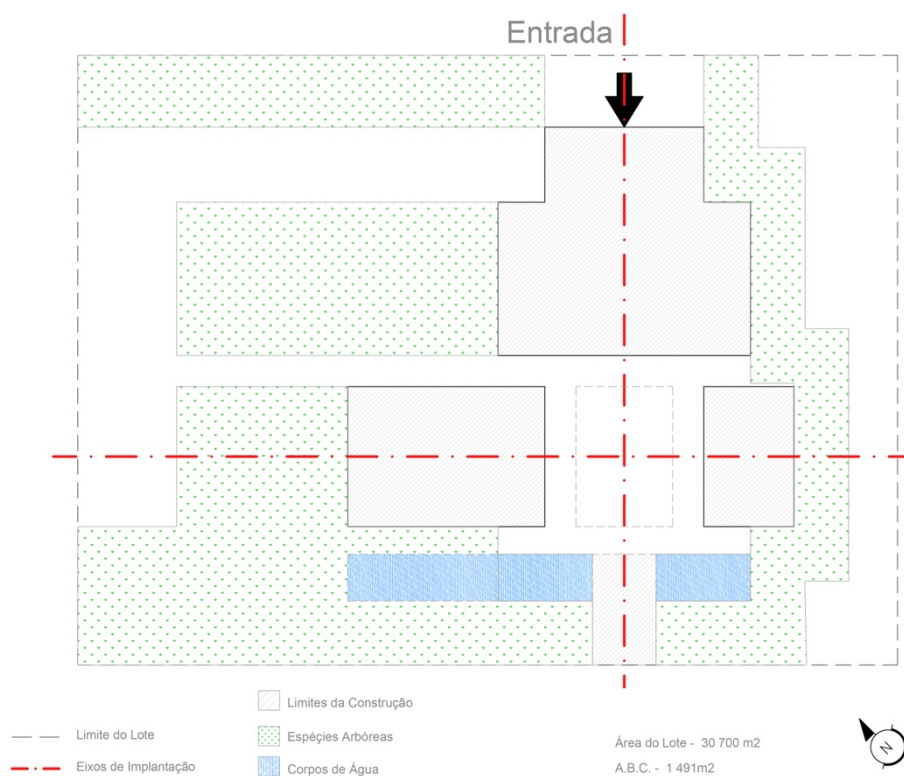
Esquema de Implantação e eixo de simetria da Villa Laurentina (ilustração do autor)
